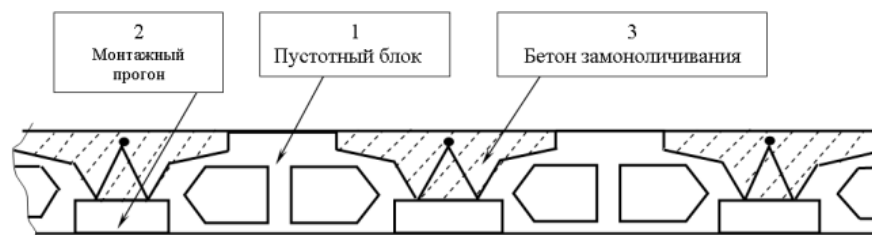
Поперечный переріз перекриття за типом німецької системи «ALBERT»
